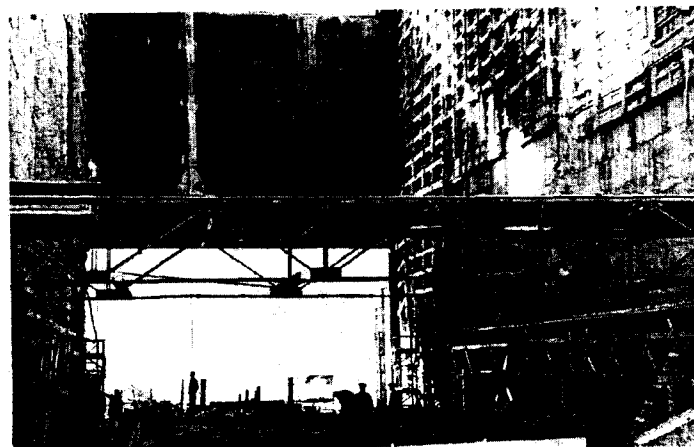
Монтаж подвижного шатра в пролете водосливной плотины при бетонировании гребенки на Бухтарминской ГЭС
